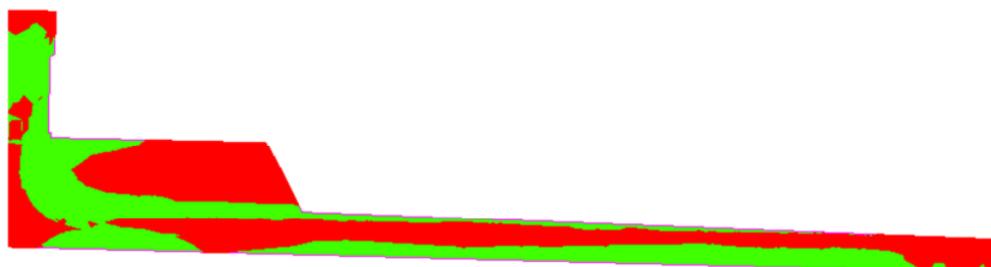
Planimetria Scavo di Livellamento Area Sud Impianto
